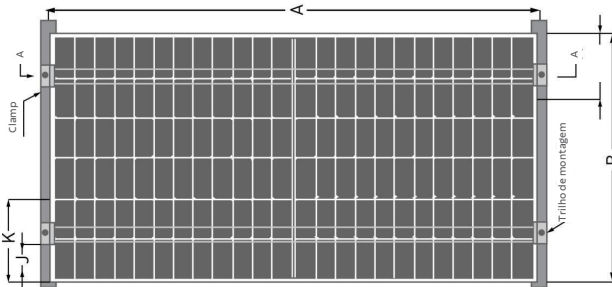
Instalação de braçadeiras no lado curto das estruturas
